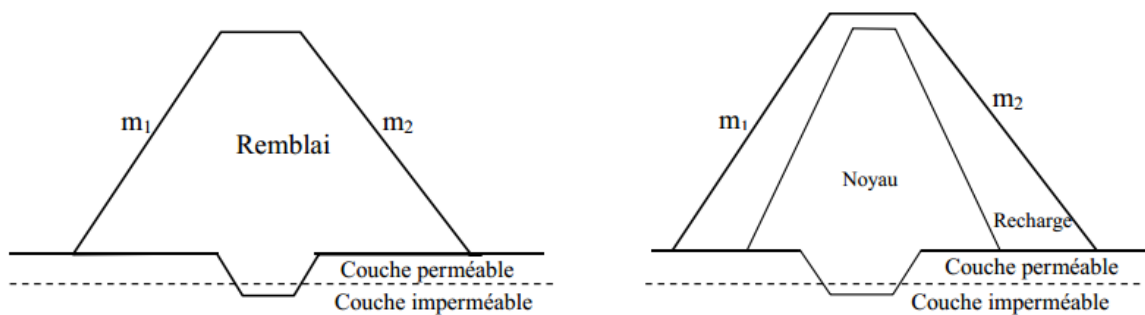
Clé d'étanchéité réalisée dans les fondations de barrage en terre
